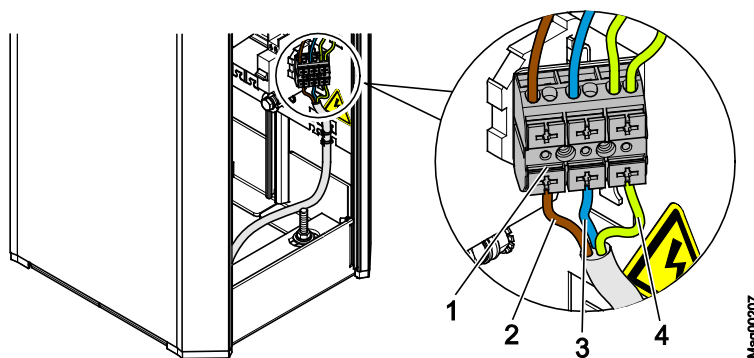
Prowadzenie sieciowego przewodu zasilającego
